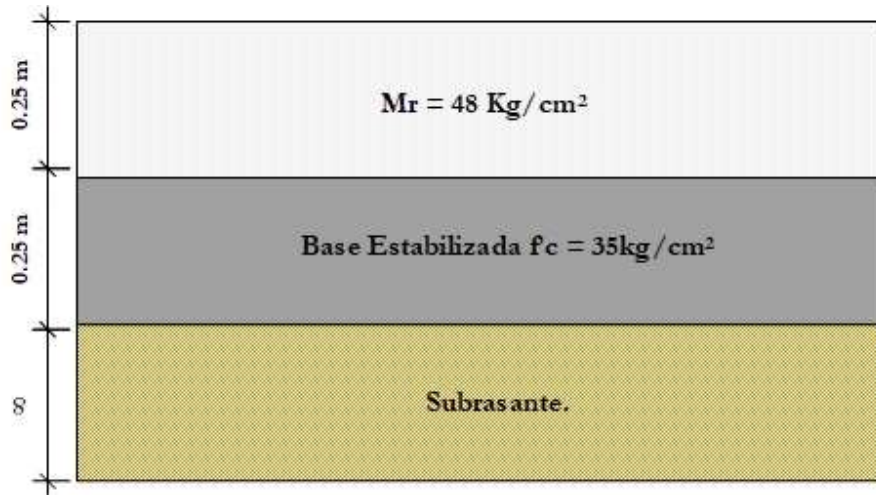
Estructura pavimento CA01W - RN23S - RN07W
